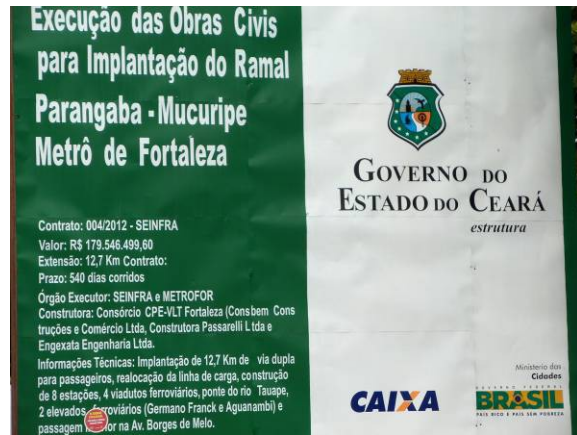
Placa da obra localizada na Avenida Aguanambi
